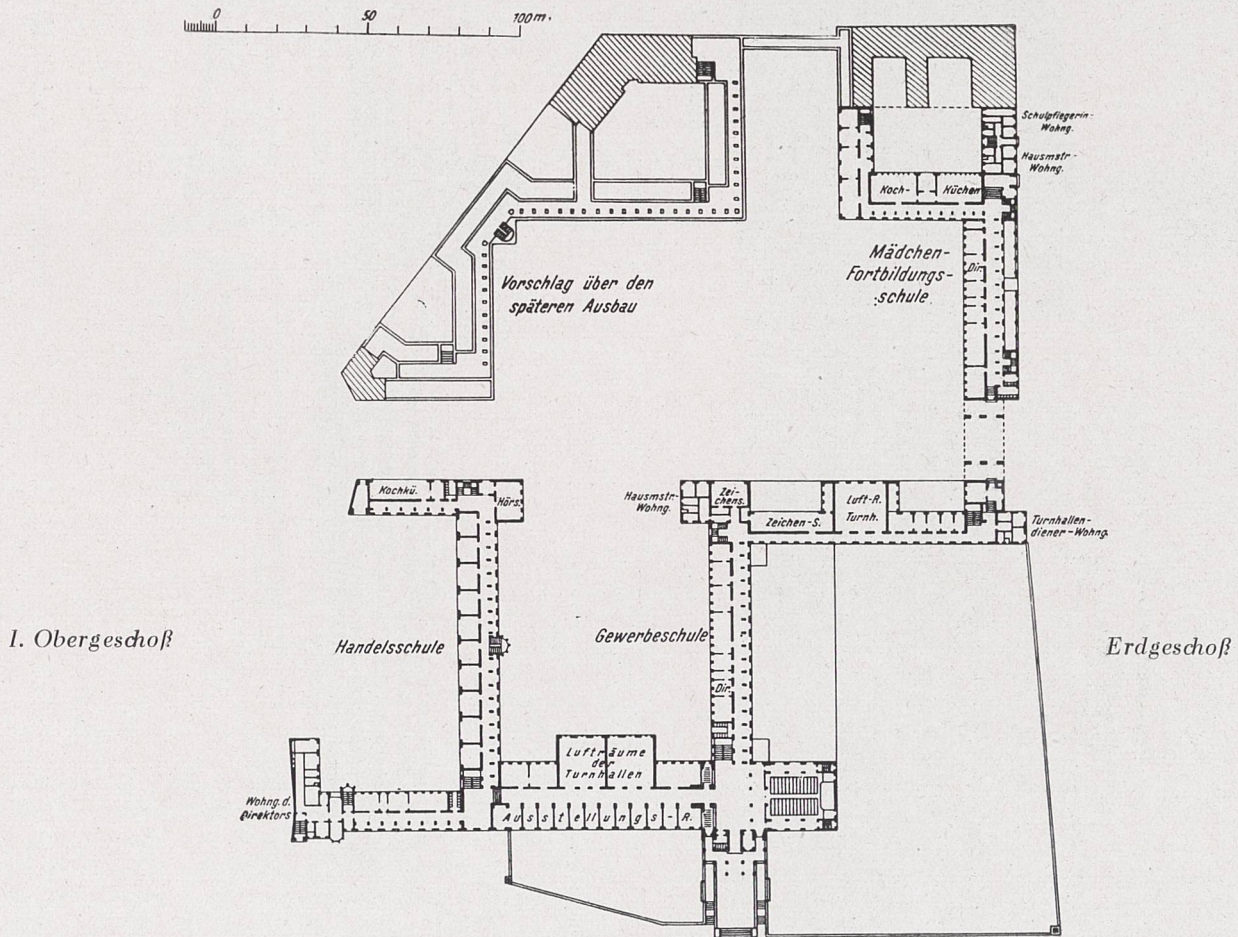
Grundriß vom Erdgeschoß und I. Obergeschoß.
